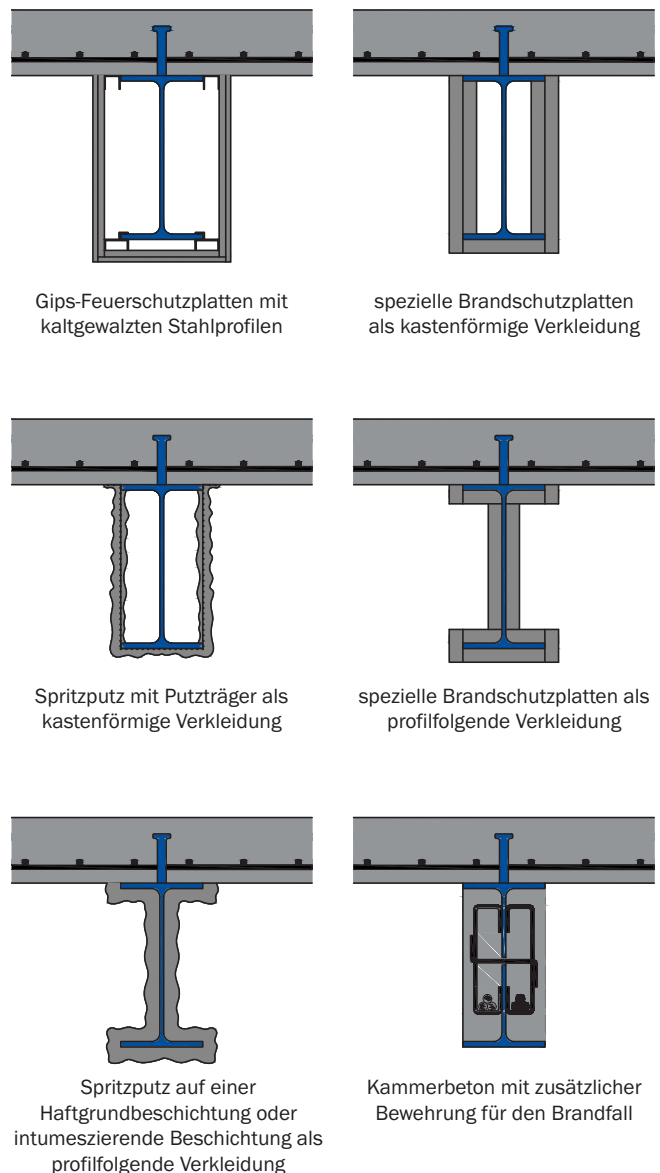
Brandschutzmaßnahmen für Stahl- und Verbundkonstruktionen am Beispiel eines IPE-Deckenträgers mit dreiseitiger Brandbeanspruchung
